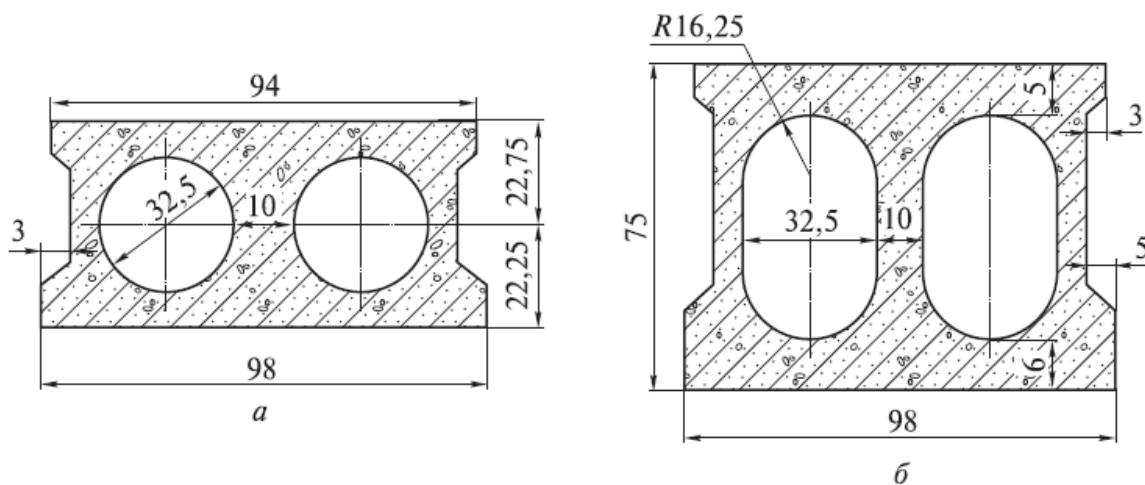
Поперечные сечения блоков плитных пролетных строений с круглыми (а) и овальными (б) пустотами
